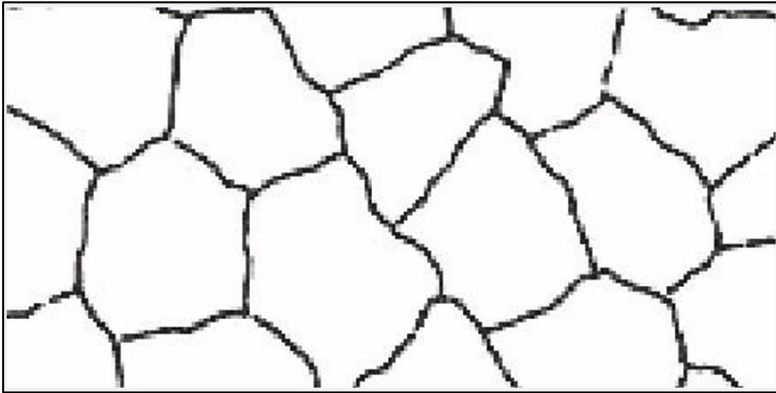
Patrón típico de fisuras producida por retracción por secado.
